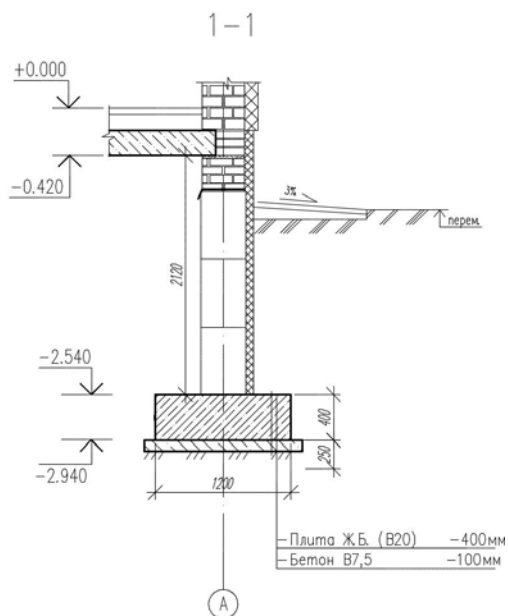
Разрез 1-1 ленточного фундамента под крайнюю несущую стену
